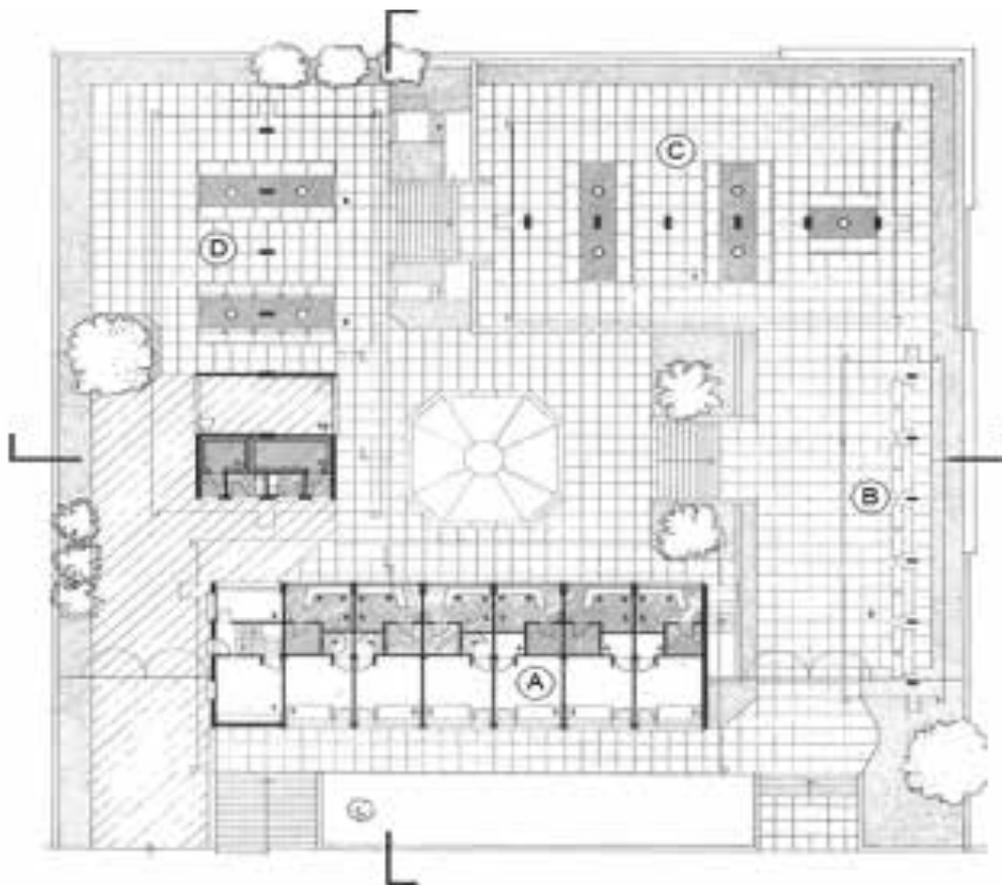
Planta geral do Mercado da Vila da Feira (Santa Maria da Feira, Portugal) ([adprojeto do Arqt. Fernando Távora (adaptado a partir de:] Távora, 1993)
